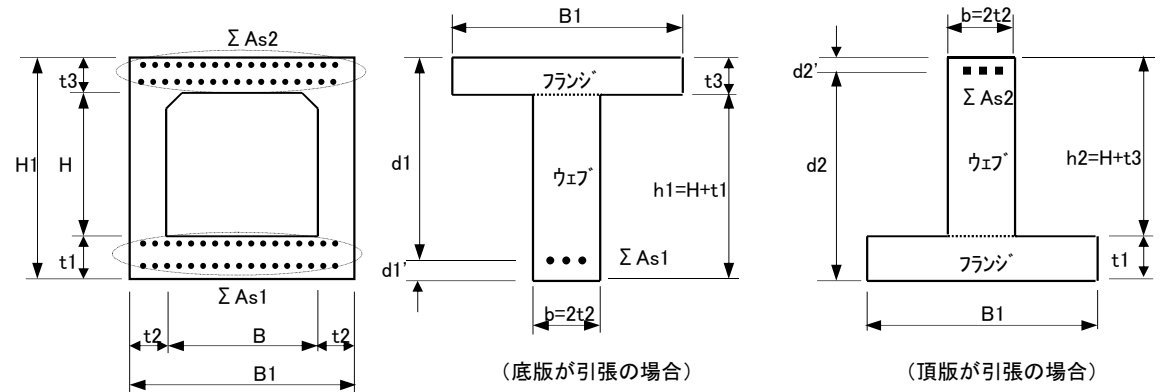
鉄筋コンクリート函体の断面の計算方法
